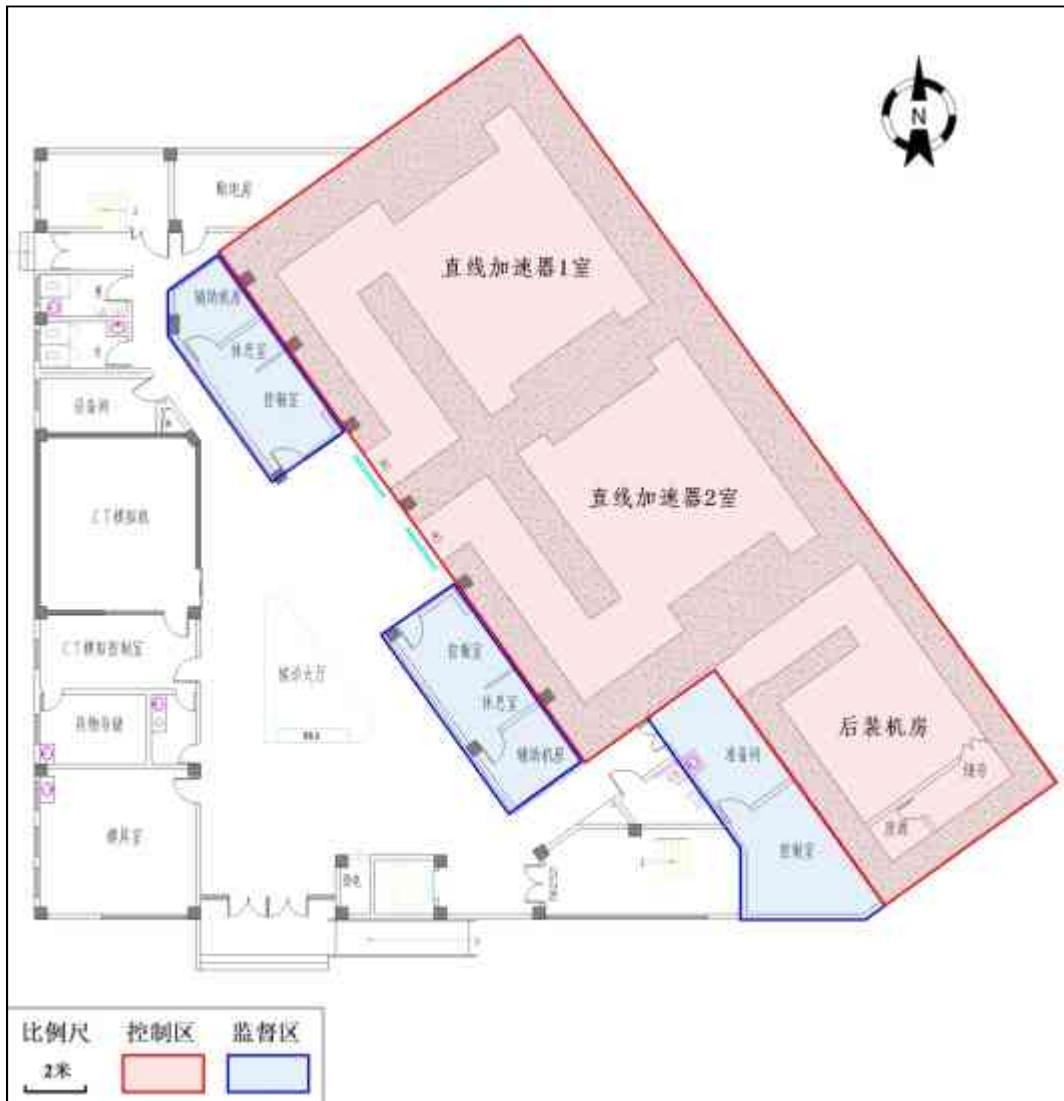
肿瘤放疗中心放疗机房平面布置及分区示意图
